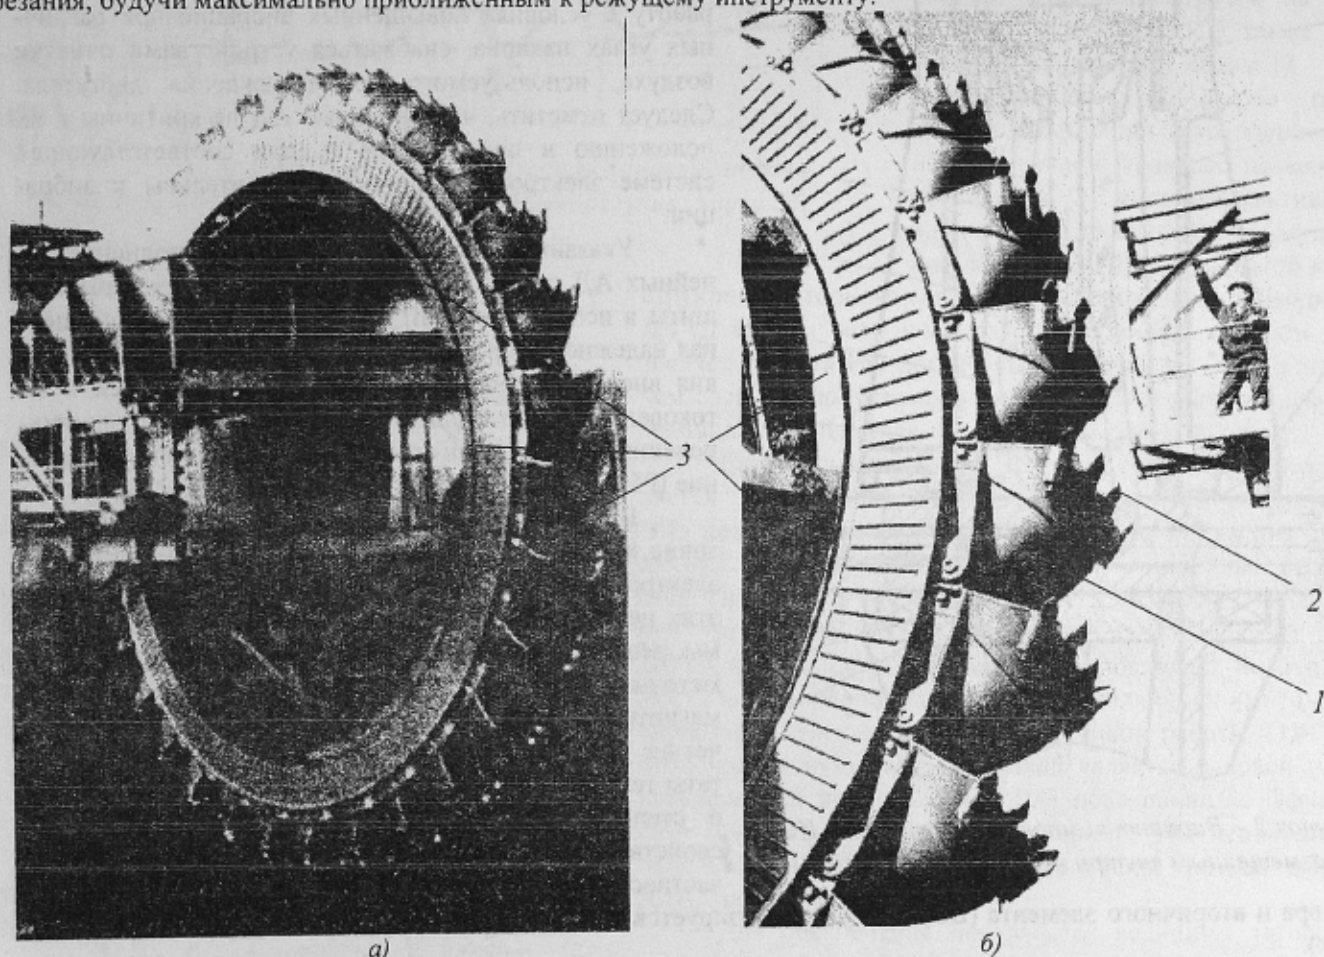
Исполнительный орган роторного экскаватора:
